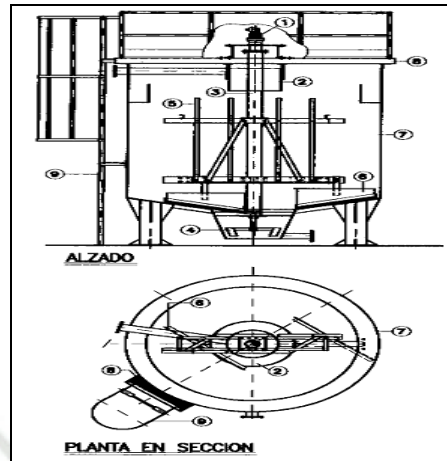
ESPESADOR POR FLOTACIÓN INSTALADO CUBA DE HORMIGÓN TIPO TGEFH
